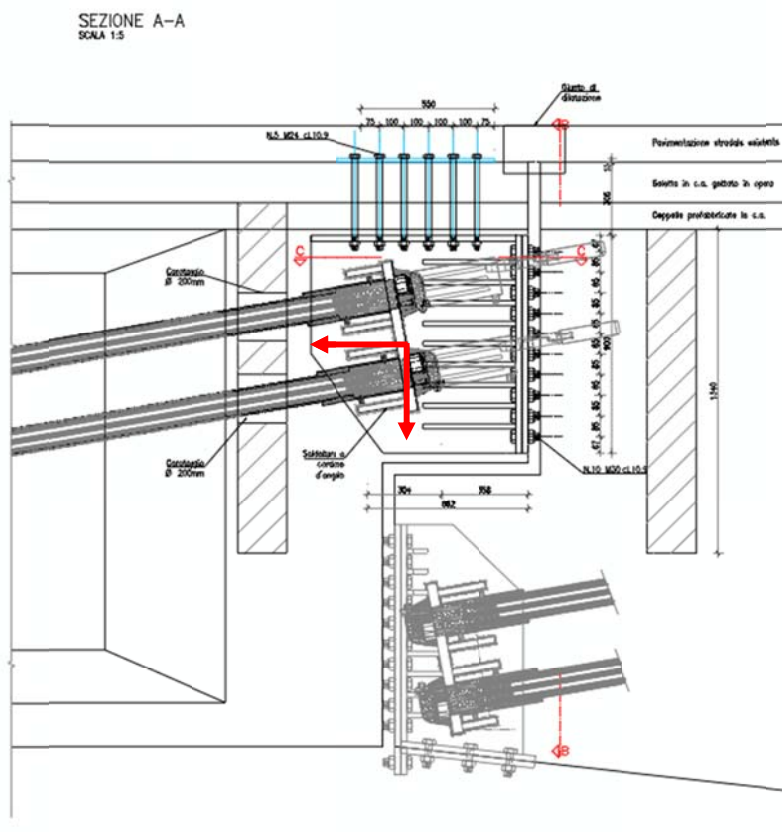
Ancoraggio di testa su trave tampone e componenti di forza
